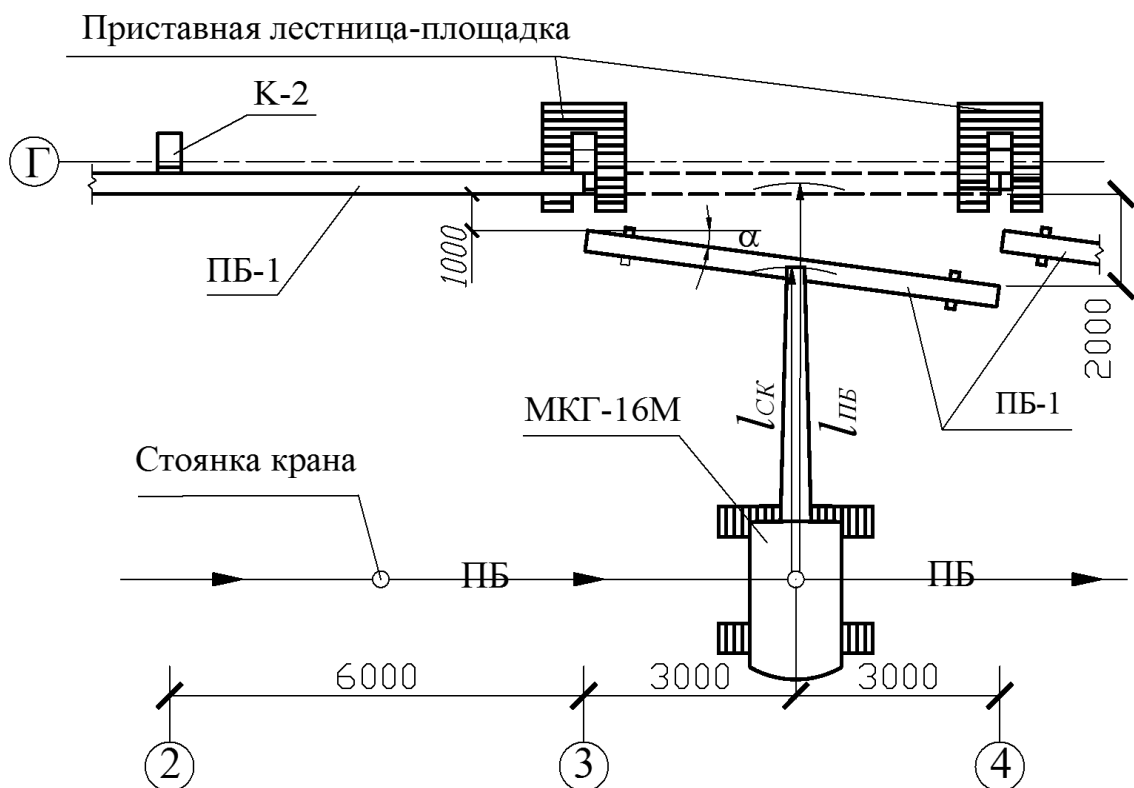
Схема монтажа подкрановых балок изменением вылета стрелы
